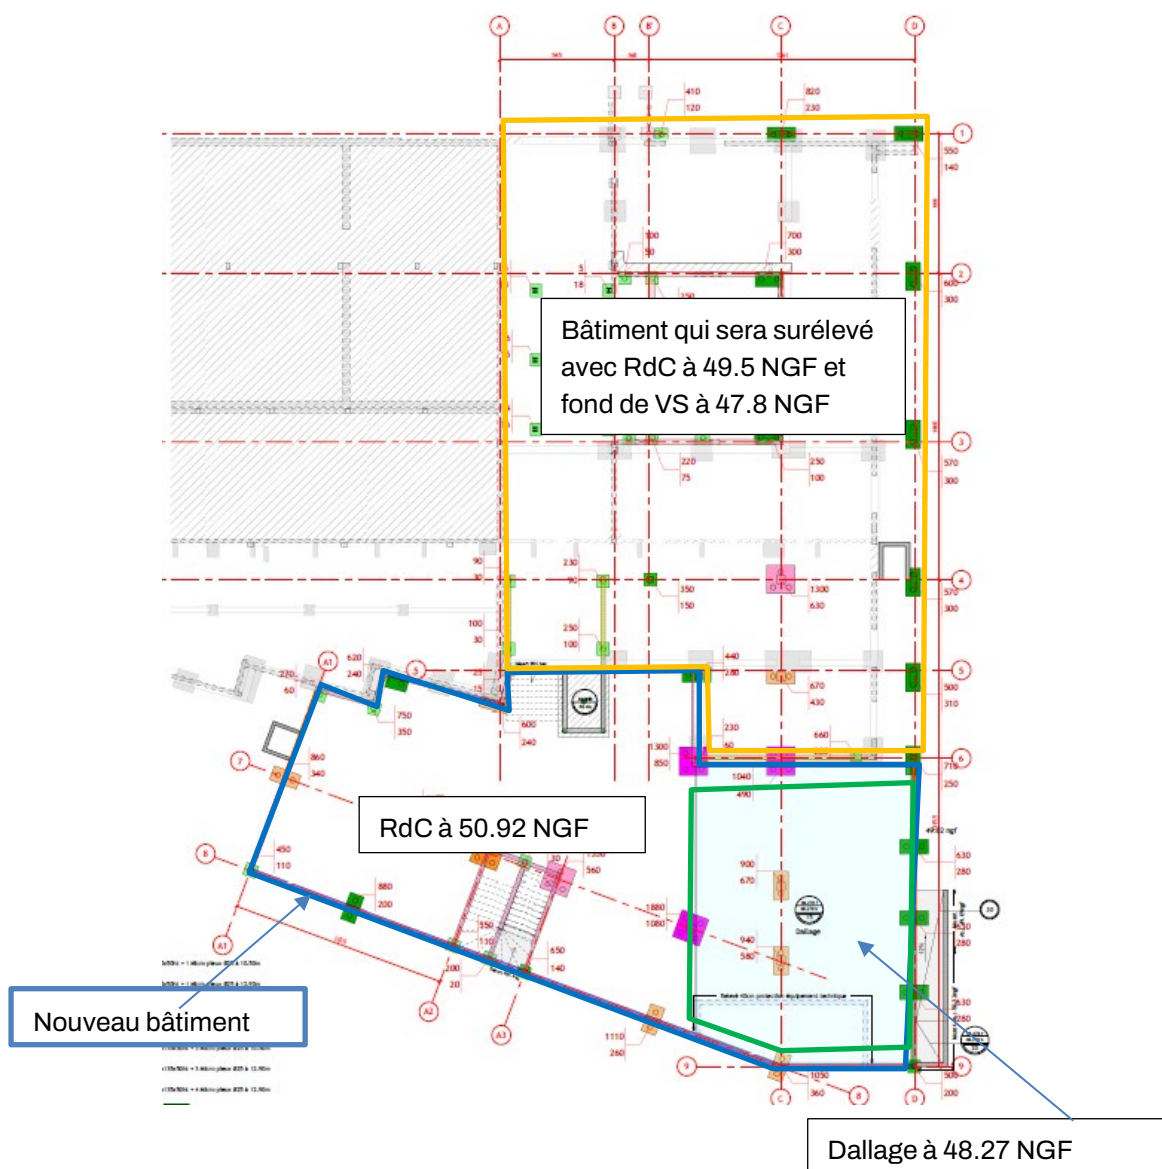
Extrait du plan de fondation CALDER, annoté par nos soins
